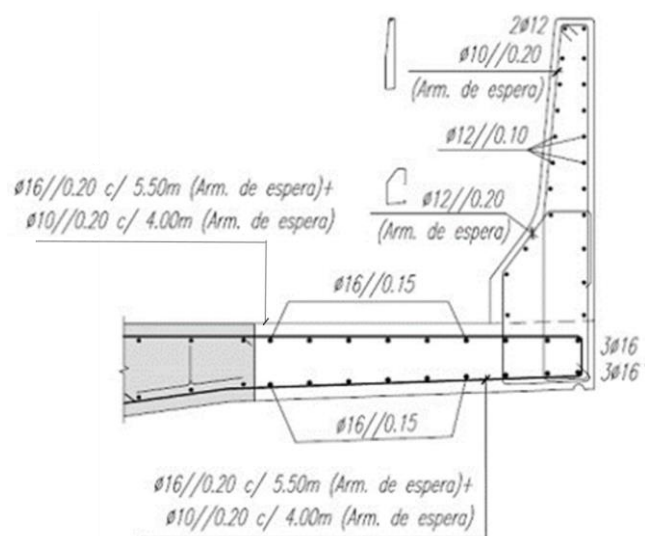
Pormenorização de armaduras do tabuleiro e da barreira de segurança, adaptado de Mendes [15]
